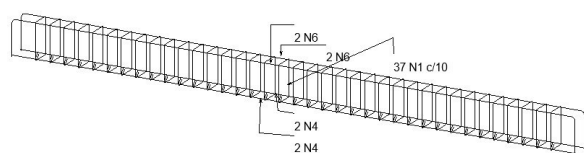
Vistas geradas de modelos de estruturas no REVIT
